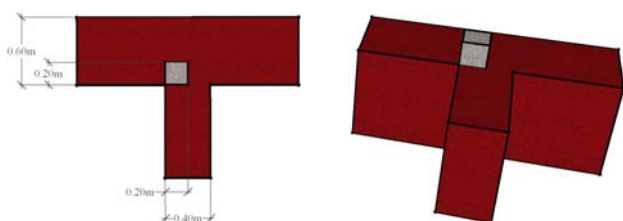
À esquerda, visualiza-se em planta o montante na ligação entre duas paredes ortogonais, em betão armado, e, à direita, o mesmo montante em perspectiva
